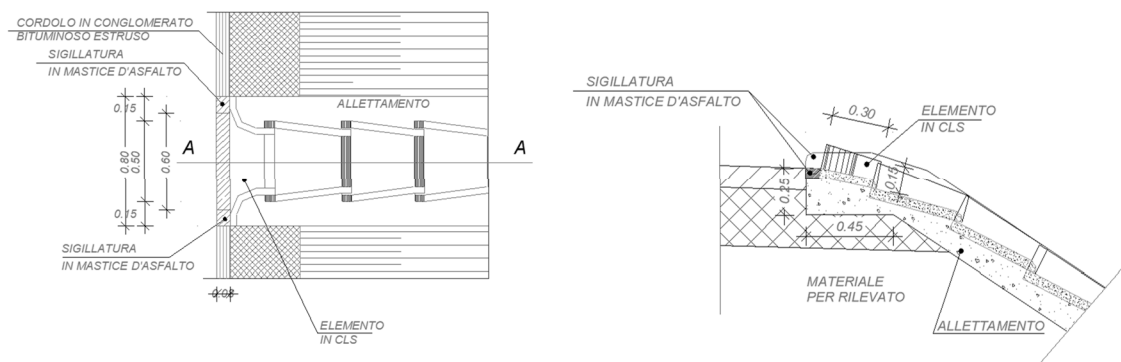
Dettaglio in pianta e sezione testa embrici su piattaforma ferroviaria
